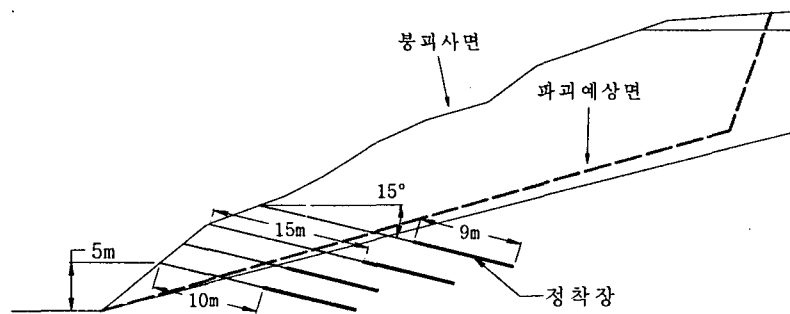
STA. No. 14+000 사면의 Rock Anchor 설치 단면도
